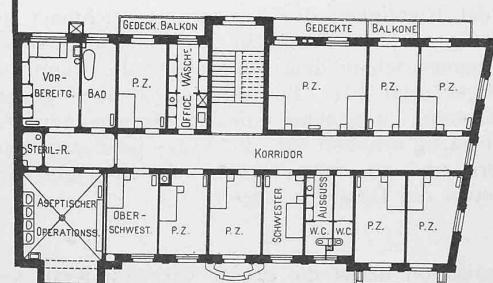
bis 6. Grundrisse vom Keller- und Erdgeschoss, sowie vom ersten Stock und Dachgeschoss.
